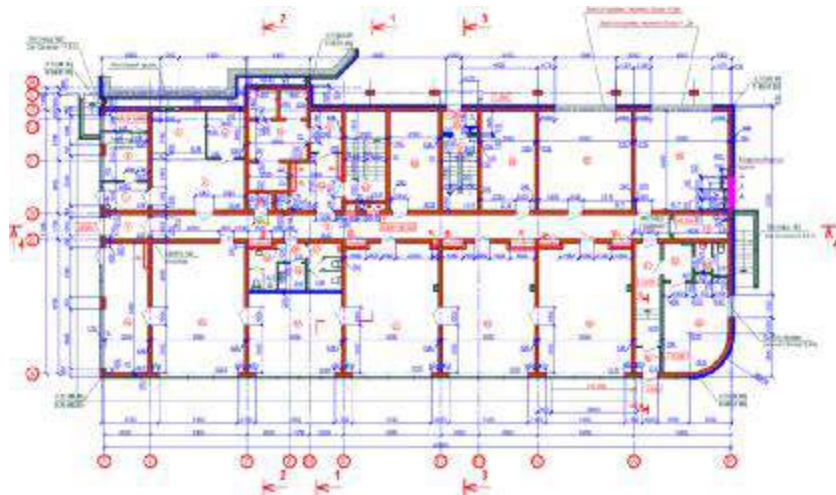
План першого поверху будівлі №1 на відм. 0.000 м
